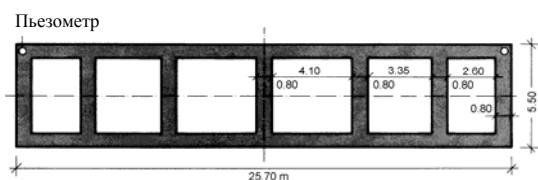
Коробчатый фундамент глубокого заложения для 866-метрового моста через реку. Фундамент со стеной в грунте за пределами русла реки (в зоне затопления) как альтернативный вариант фундамента с использованием внутренних свай
